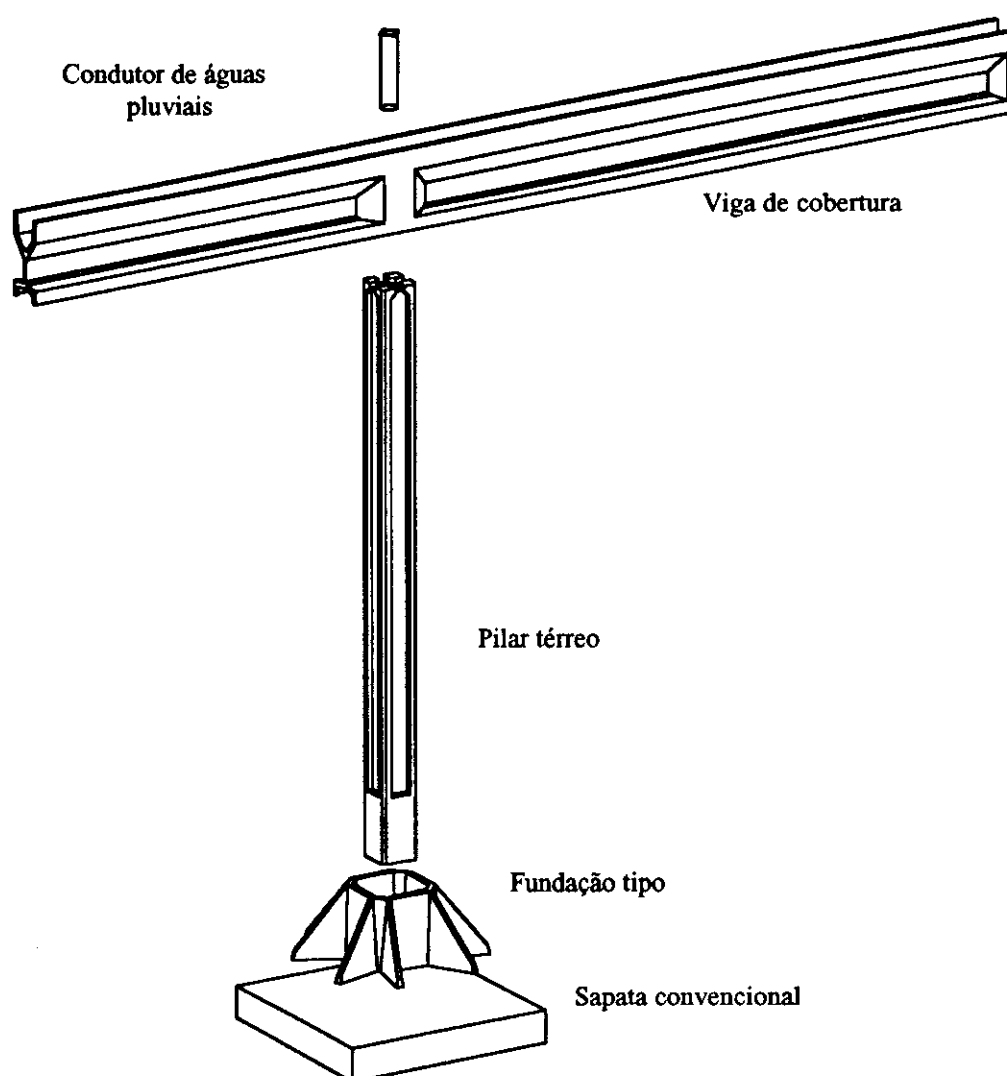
Vista em perspectiva do esquema de montagem fundação tipo – pilar – viga de cobertura
